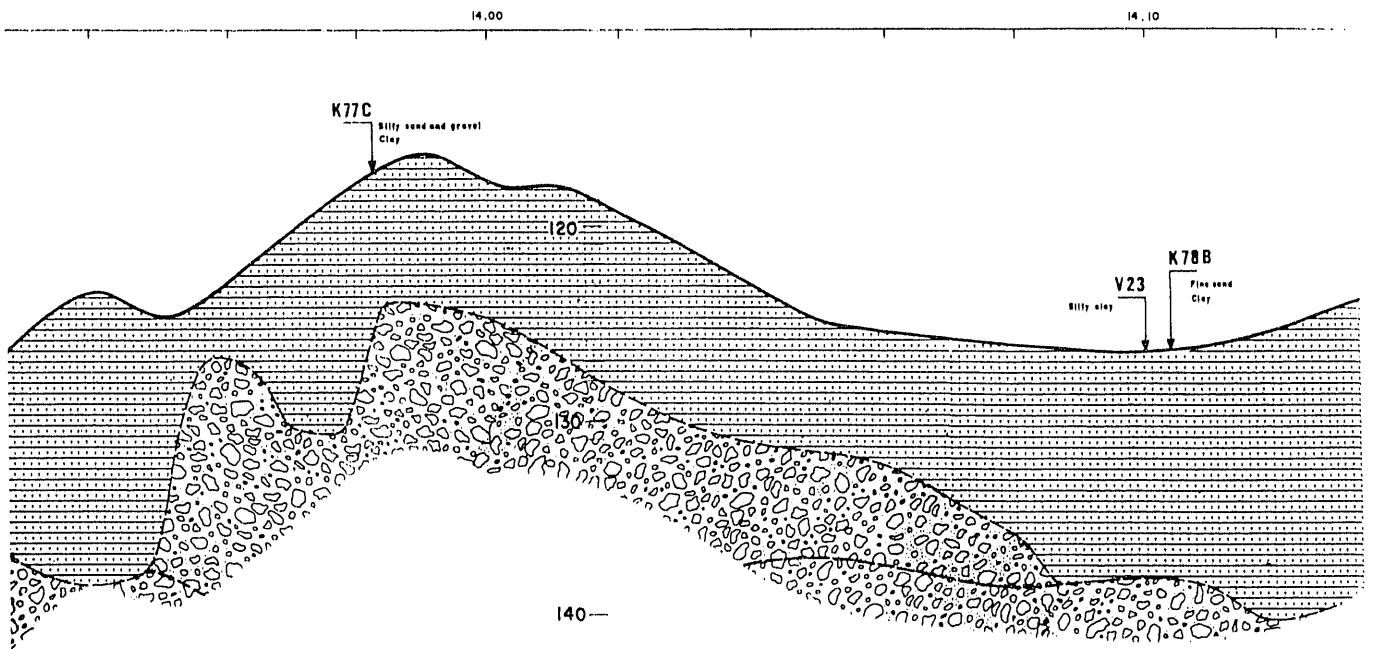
Planimetría y perfil del trazado de una tubería submarina.
